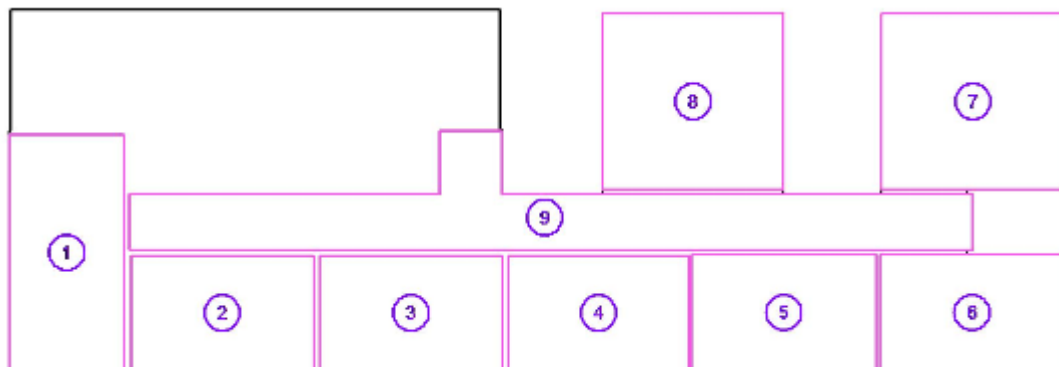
Planta de identificação das salas do primeiro andar do bloco E
